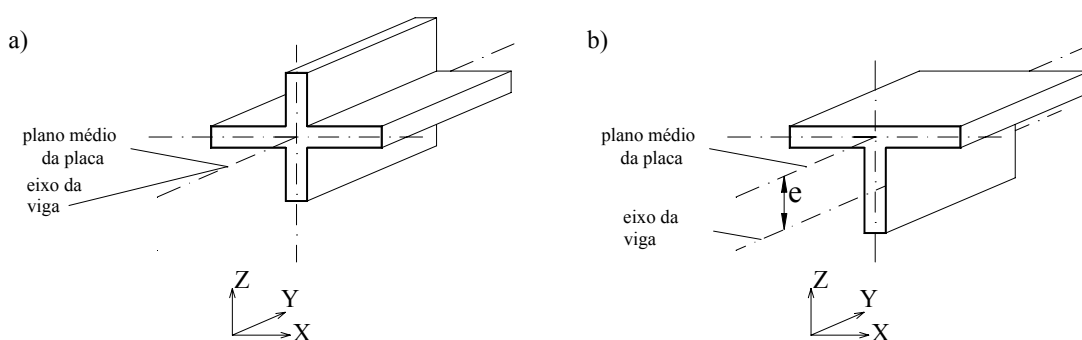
a) Viga concêntrica; b) Viga excêntrica.
